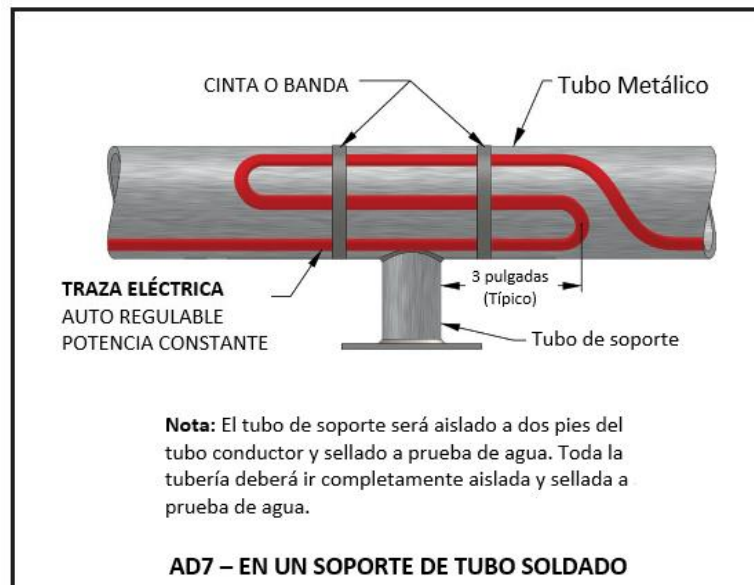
Esquema en soporte de tubo soldado.
